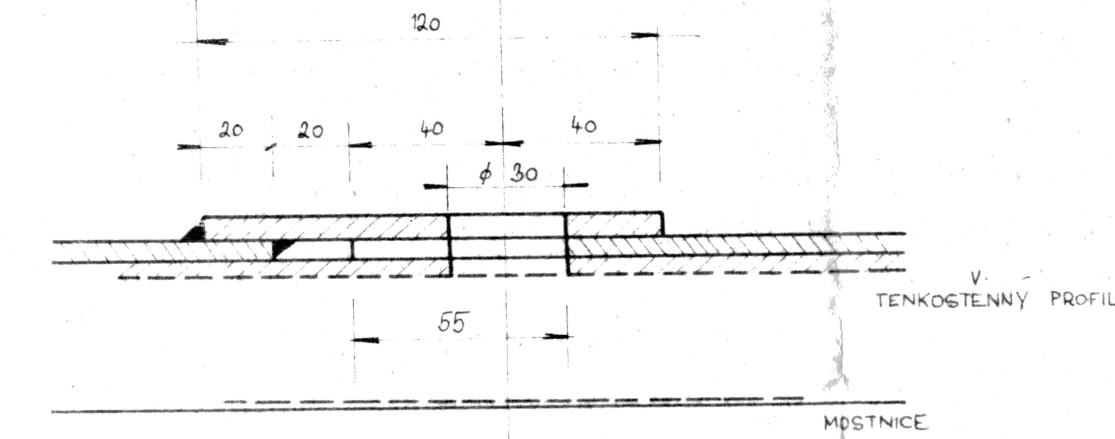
DETAIL UPEVNĚNÍ PODL. PLECHU M 1:1
